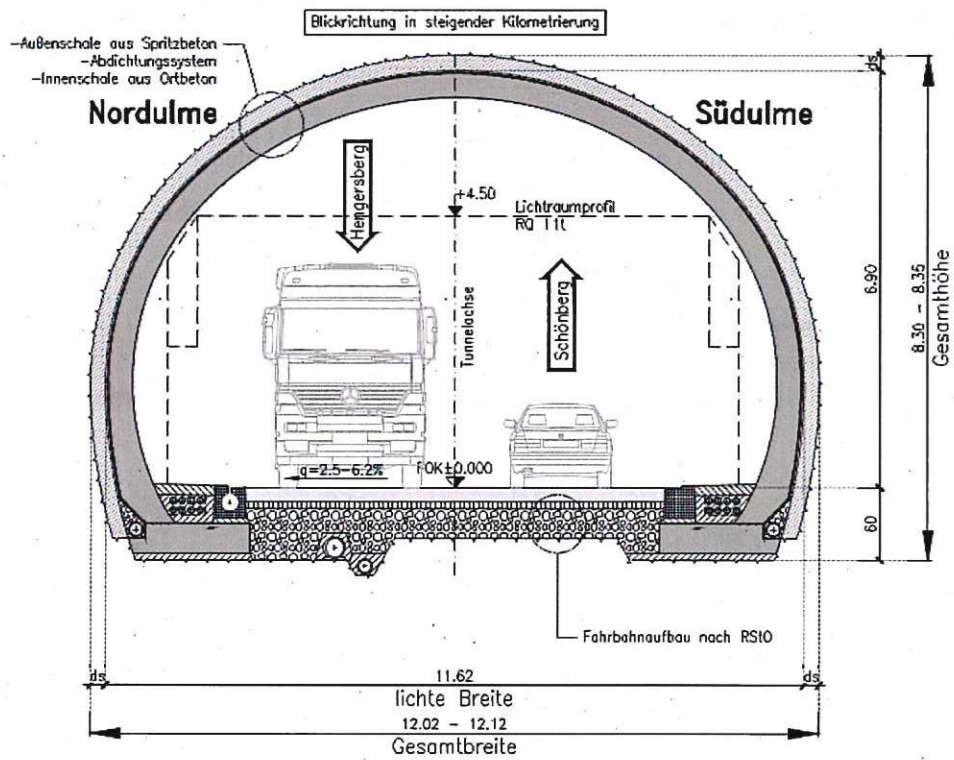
RQ 11t Tunnel mit offener Sohle (ohne Maßstab)
